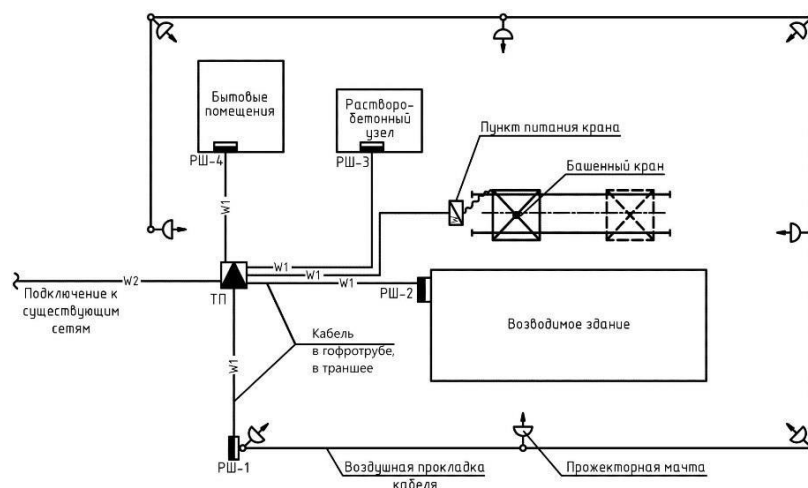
Пример схемы электроснабжения строительной площадки:
